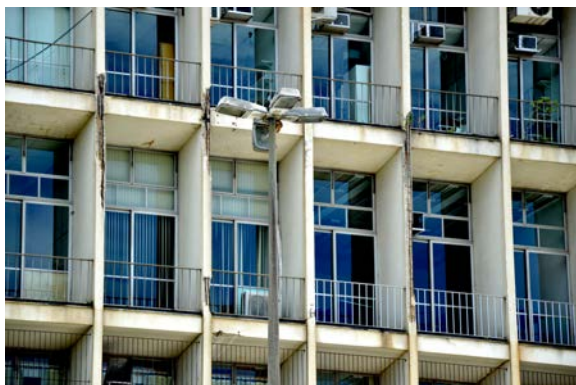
Perda de aderência entre os materiais de revestimento, acabamento e cobertura em pilares, lajes e vigas da fachada sudeste do bloco A do edifício JMM.
